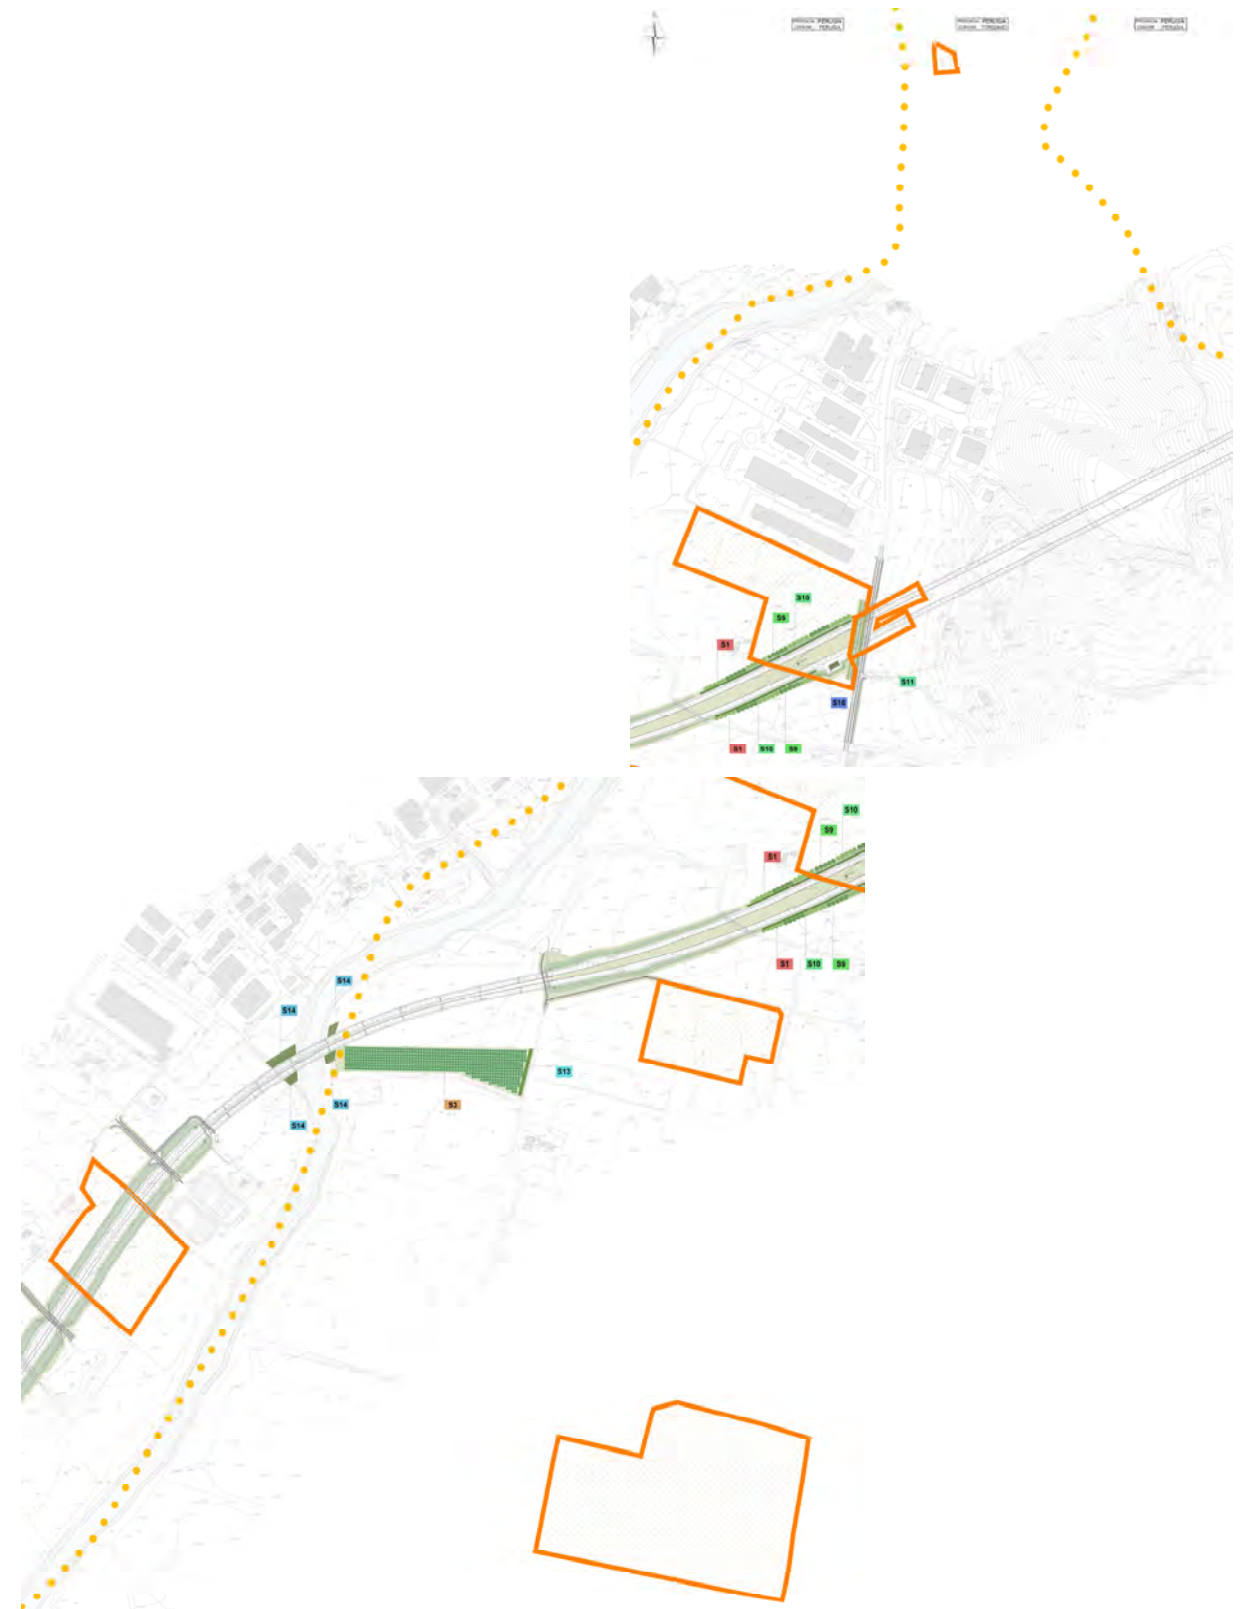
Estratto elaborato T00IA01AMBPL01 Interventi di mitigazione Planimetria d'insieme
